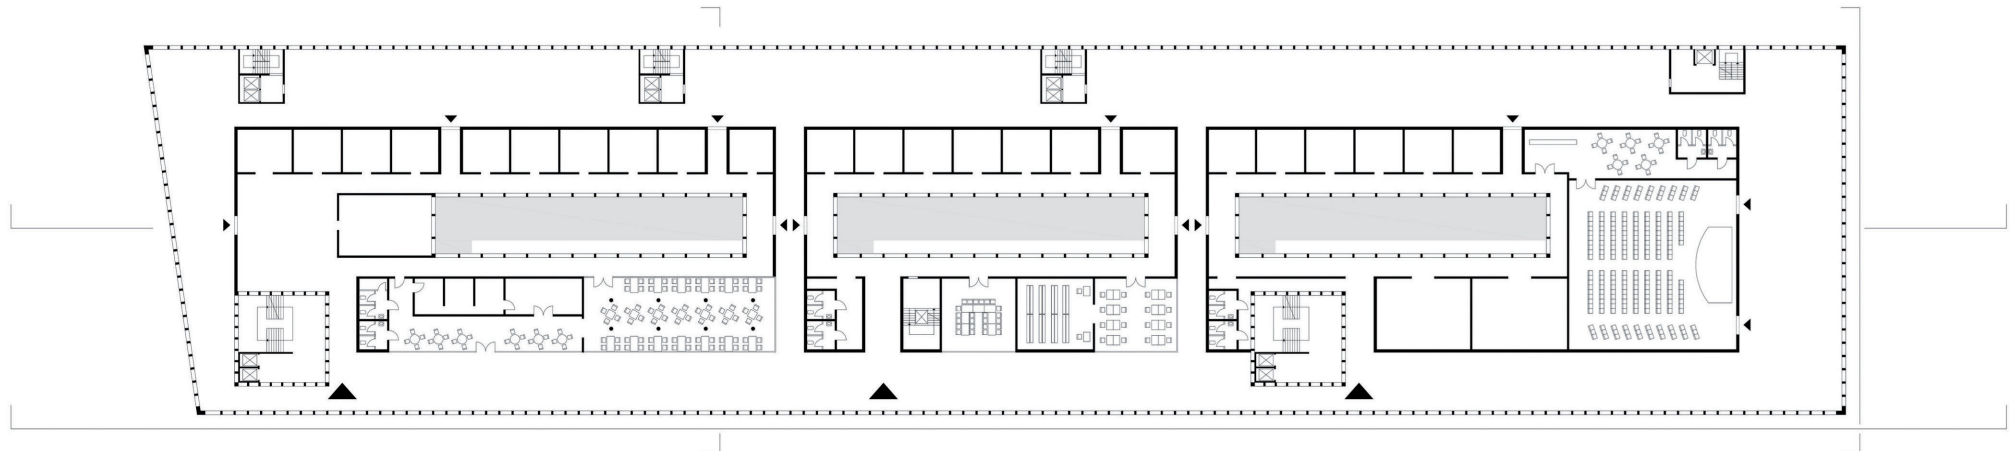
VERTIEFUNG GRUNDRISS – AUF DER AUSSICHTSEBENE, M 1:800
